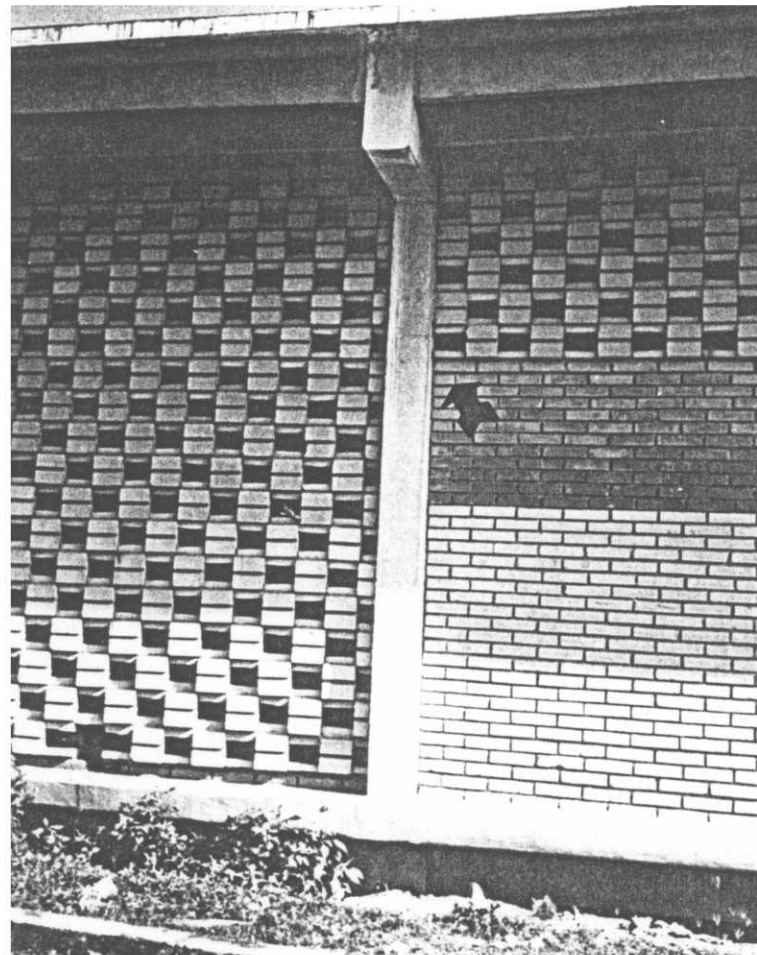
Pared de bloques macizos y de ventilación. Nótese LA diferencia de rigidez a ambos lados de la columna.
